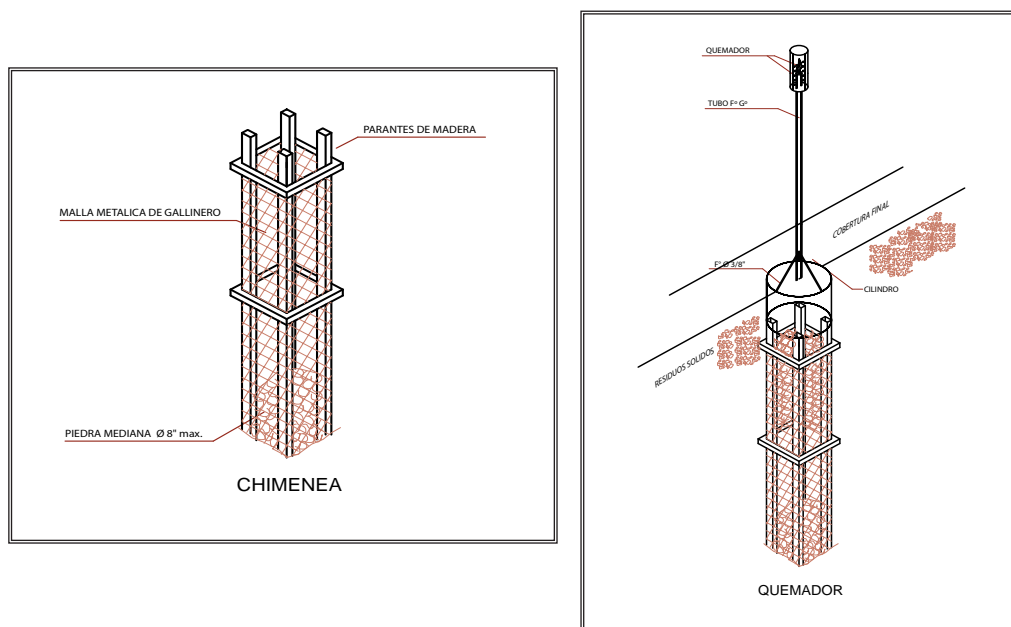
Construcción de chimenea - instalación de quemador.
